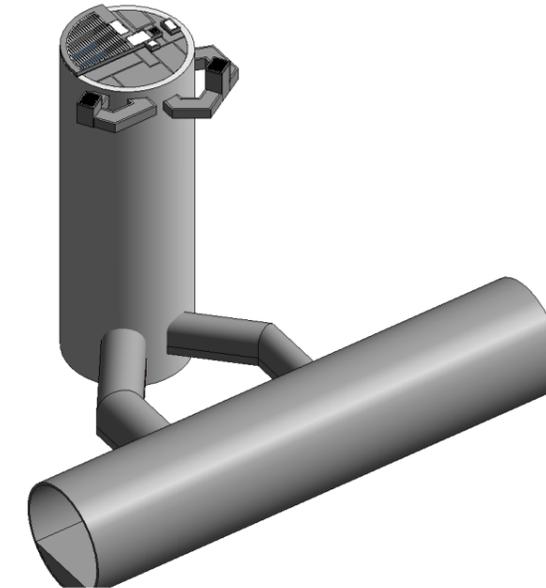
Vue d'ensemble Ouvrage de ventilation désenfumage et accès de secours / rameaux d'accès au tunnel / tunnel
